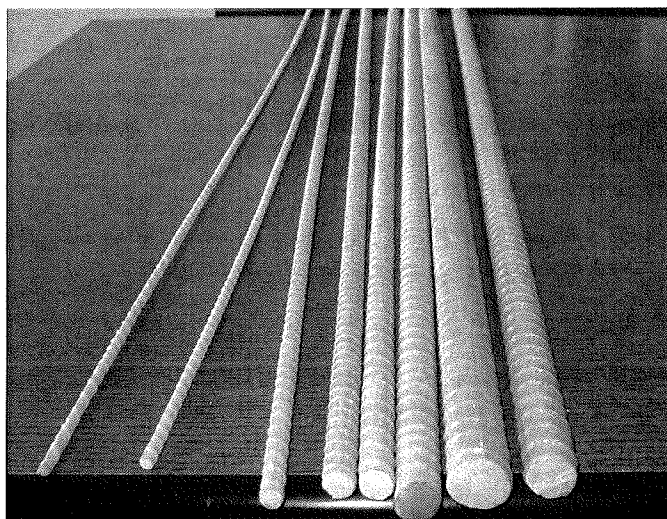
Bare din material compozit pentru armarea betonului Ø4 – Ø16 mm.
